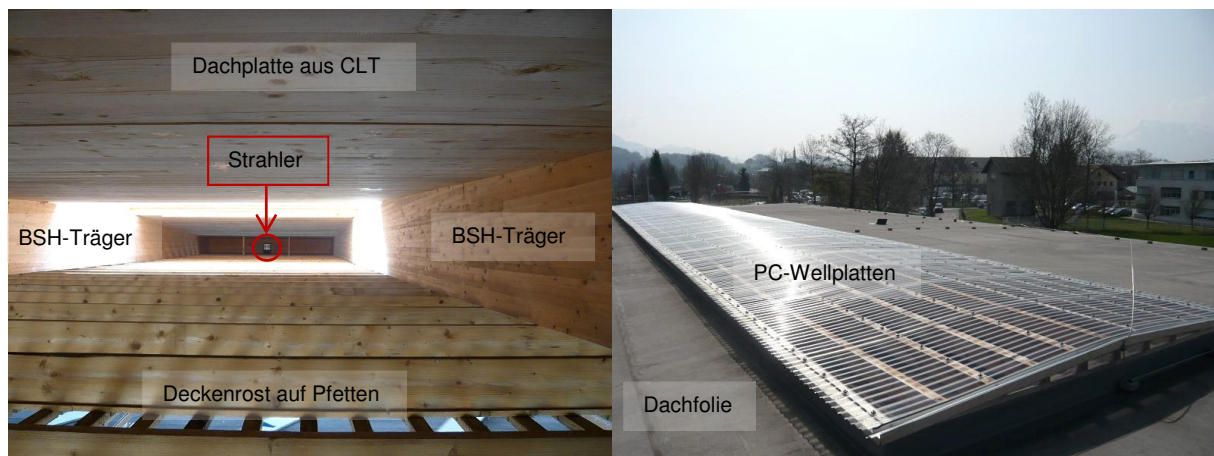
Dachraum und Oberlicht der Eishalle Bergheim³
